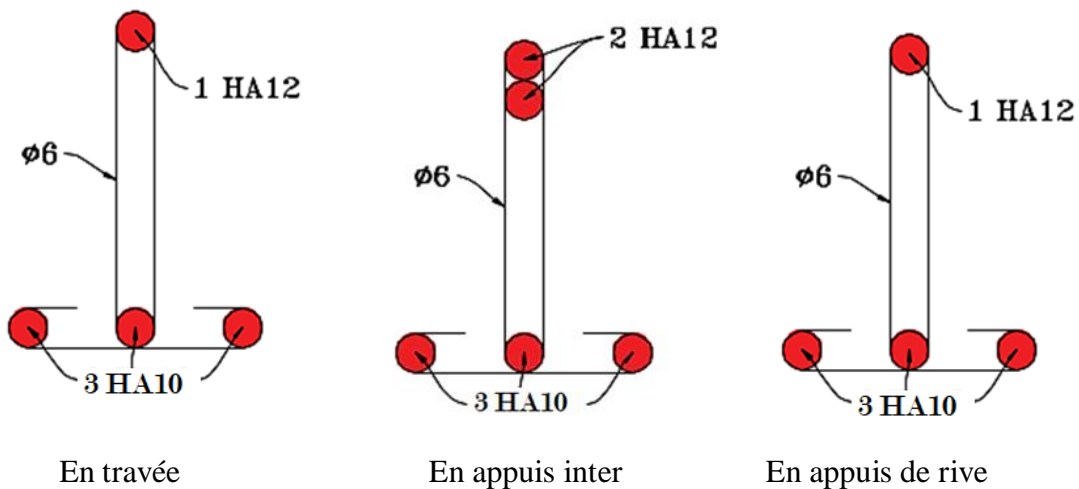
Schémas de ferrailage des poutrelles de la terrasse inaccessible
